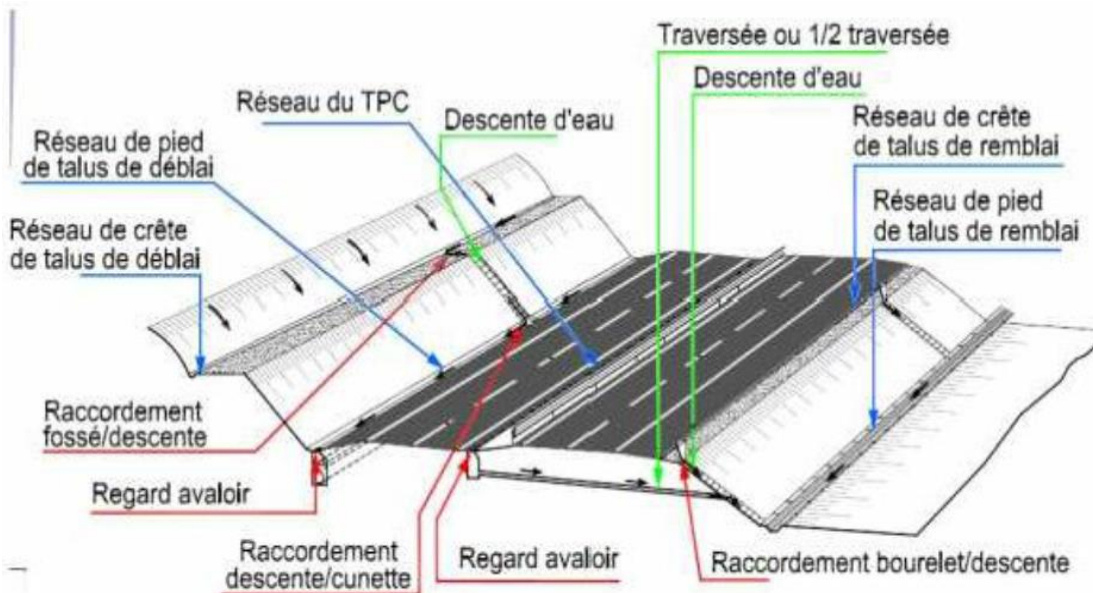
Réseaux d'assainissement d'une chaussée routière
